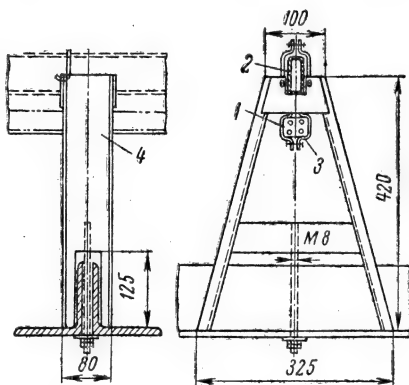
Крепление шинпровода ШОС67 на стойках поперек металлических ферм.
